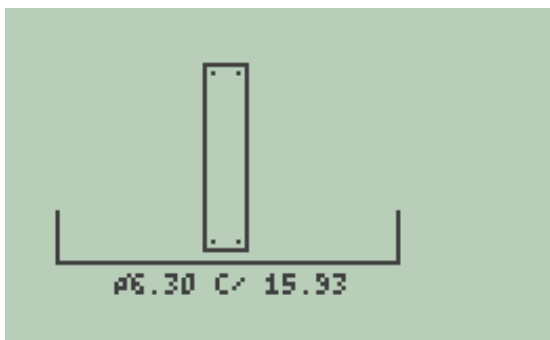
Sapata corrida com viga de rigidez - Detalhamento da armadura transversal da laje.
